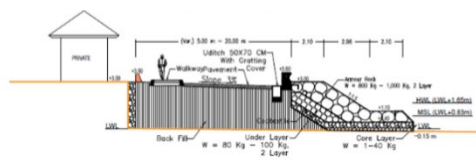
Coastal Facility Plan Indramayu Section-1b
